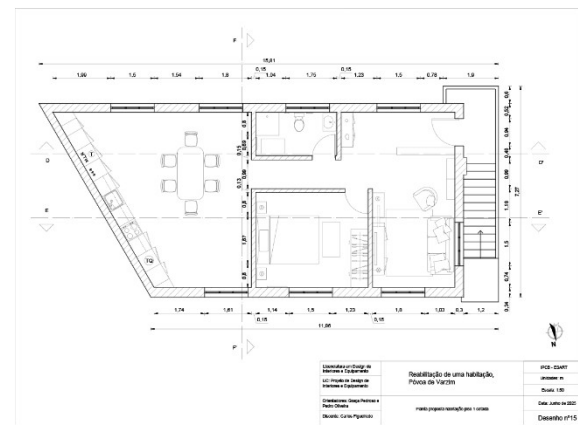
Planta Cotada Habitação Piso 1. Fonte: Autor.
